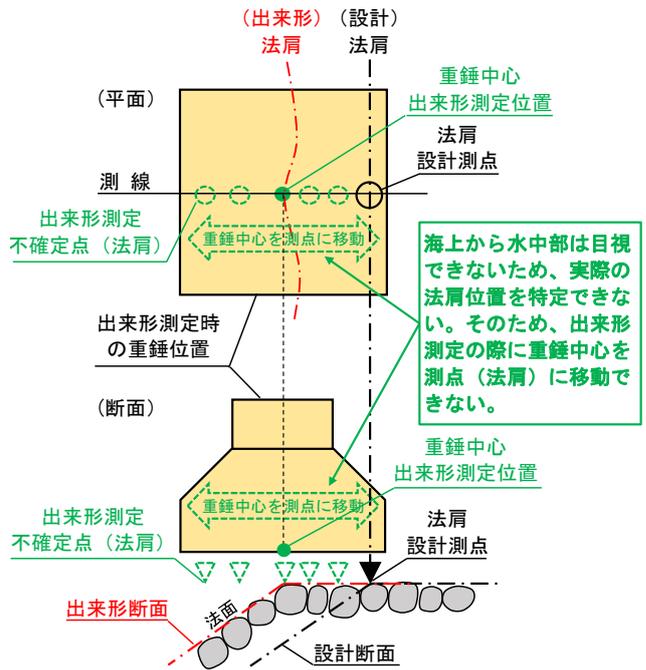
施工完了後の施工履歴データによる捨石荒均しの距離計測
